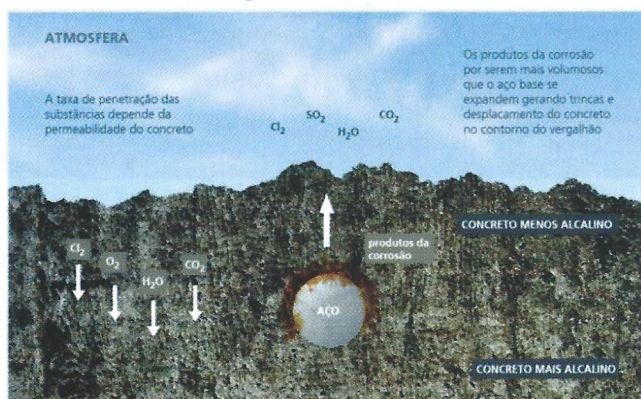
Penetração de elementos corrosivos no concreto
